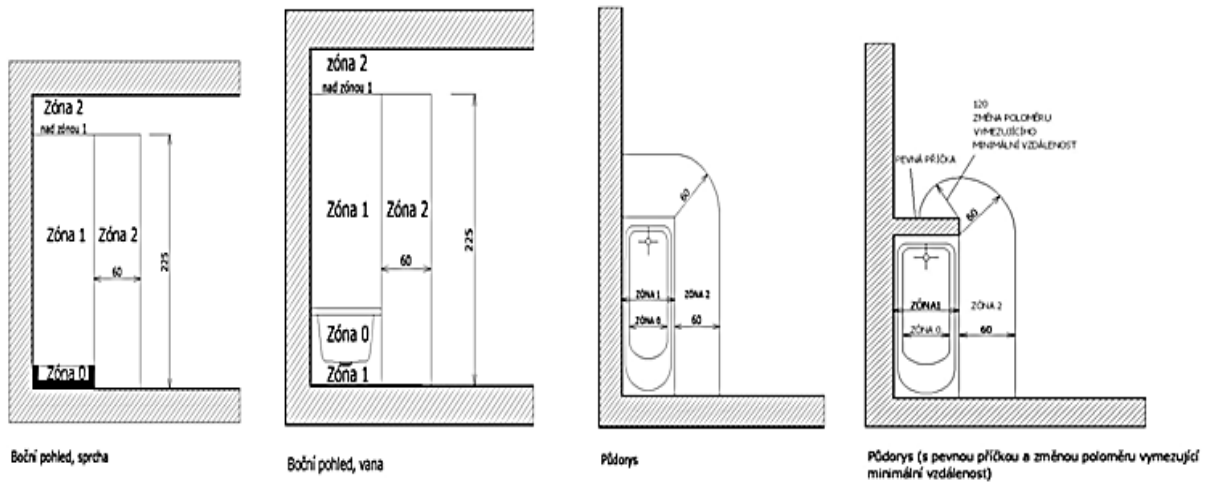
Zóny pro ukládání vedení v koupelně [26]
